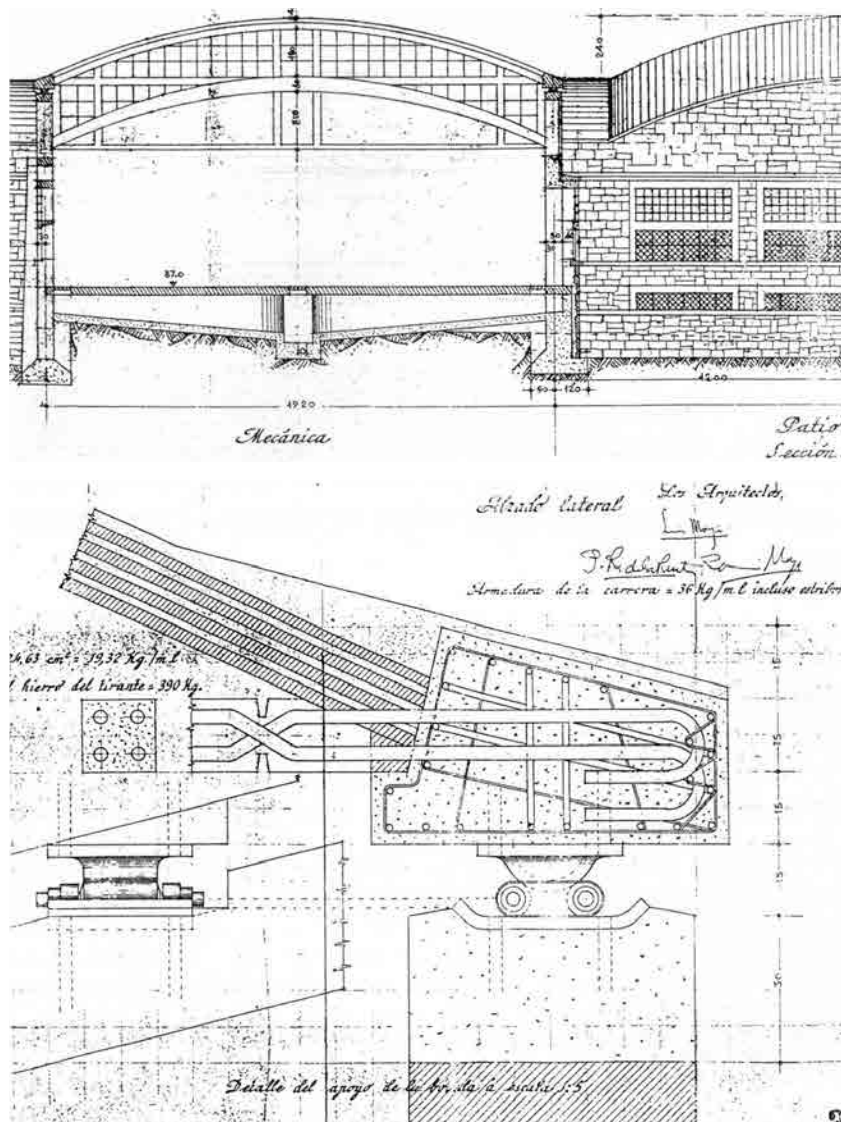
y Fig. 9 Talleres de la Universidad Laboral de Gijón. Sección de una de las naves junto a un patio (arriba) y detalle del apoyo de la bóveda en el muro (abajo).
